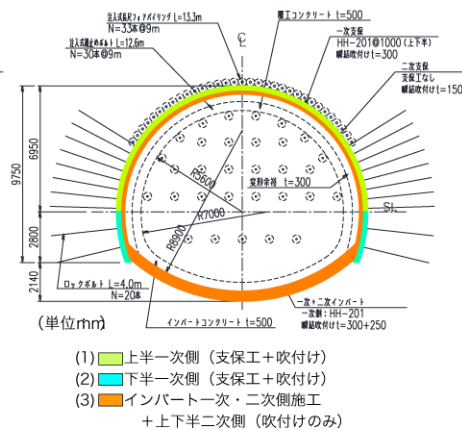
瞬結吹付けコンクリートを採用した支保パターンと施工方法¹²⁾
